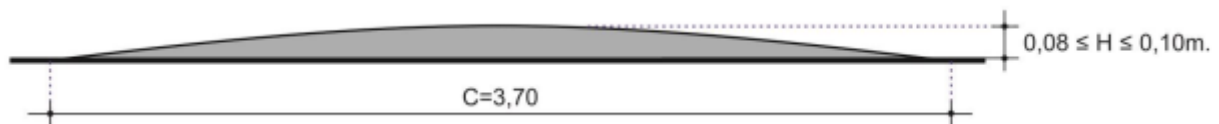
Corte transversal da ondulação transversal Tipo A. (Res. nº 600 – CONTRAM 2016)
